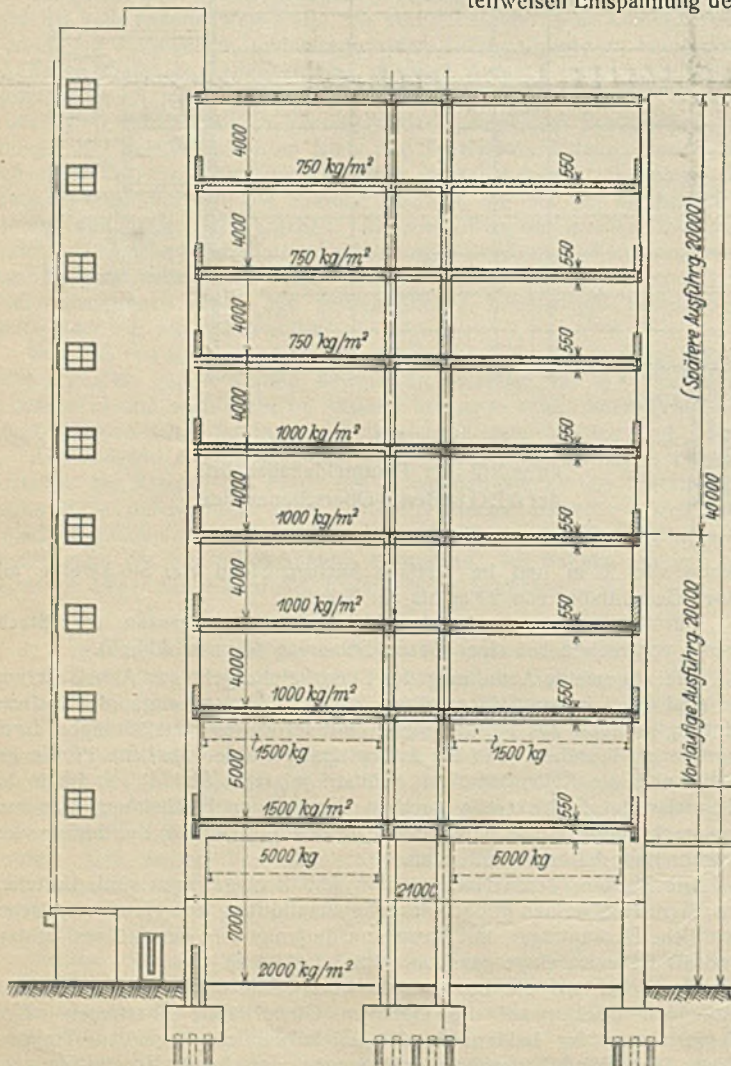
Querschnitt mit Angabe der Deckenlasten.
